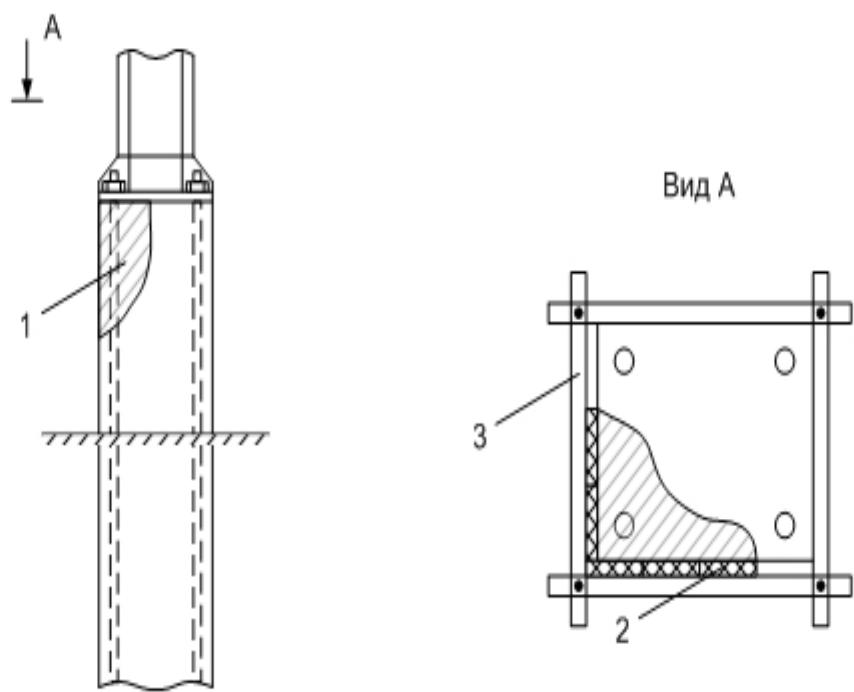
Ремонт надземной части фундамента при площади повреждения менее 1/3 площади поперечного сечения фундамента путем бетонирования:
